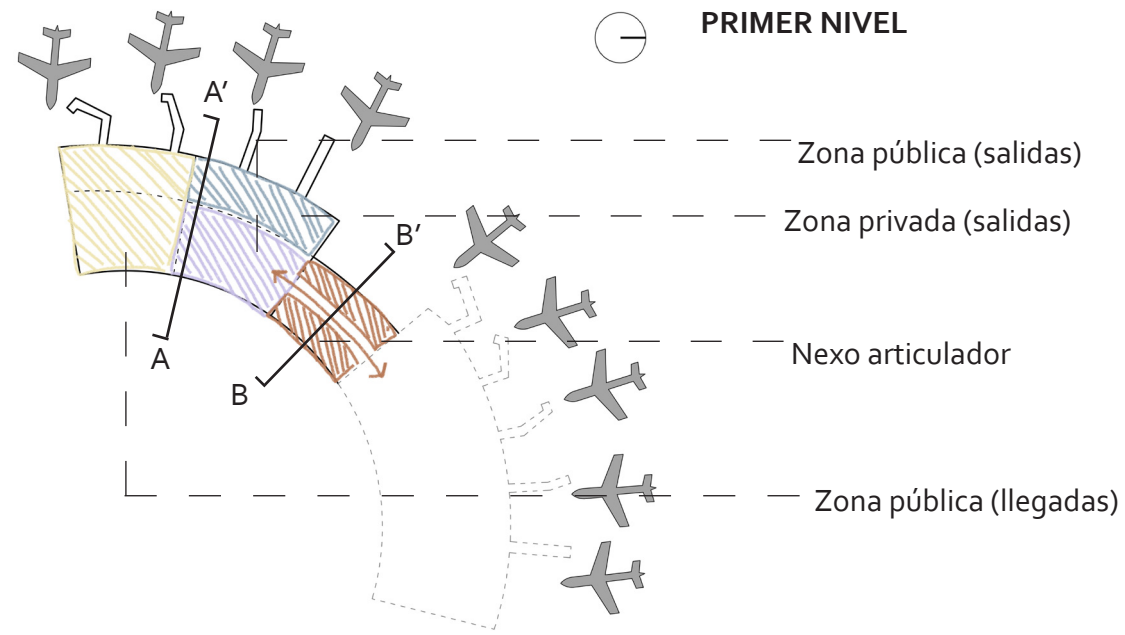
Planta primer nivel | ESCALA 1:2500 | Fuente: Elaboración propia (2023).
